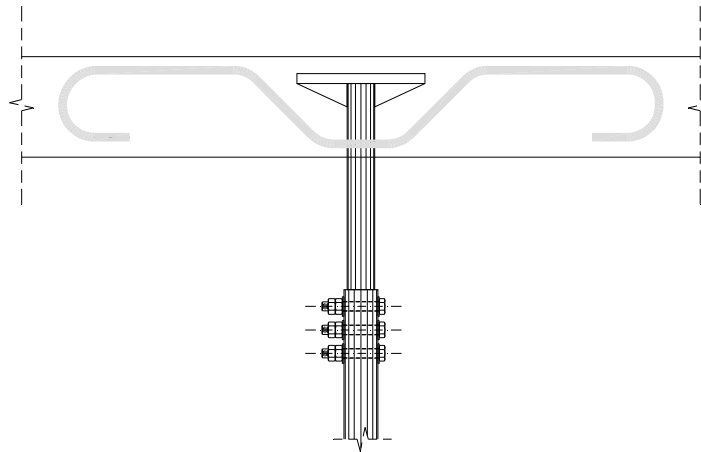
COLLEGAMENTO TUBOLARE Ø101.6X8 ALLA TRAVE IN C.A.
